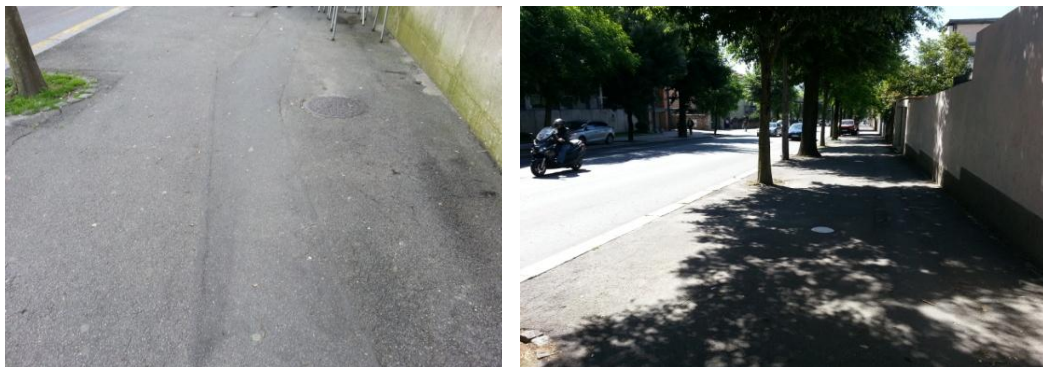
Aspeto do pavimento no trecho em betuminoso (Braga)
